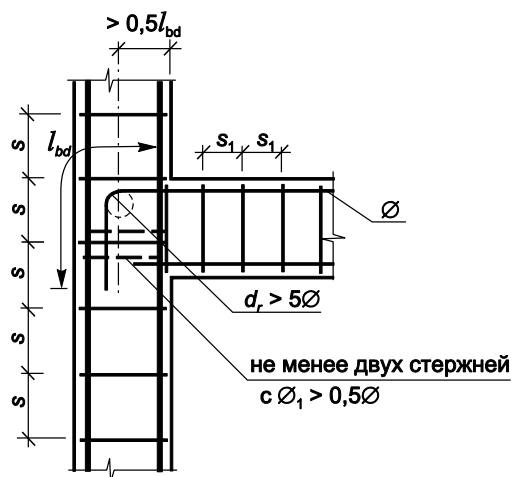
Условия анкеровки арматуры при ее отгибе в рамных узлах
